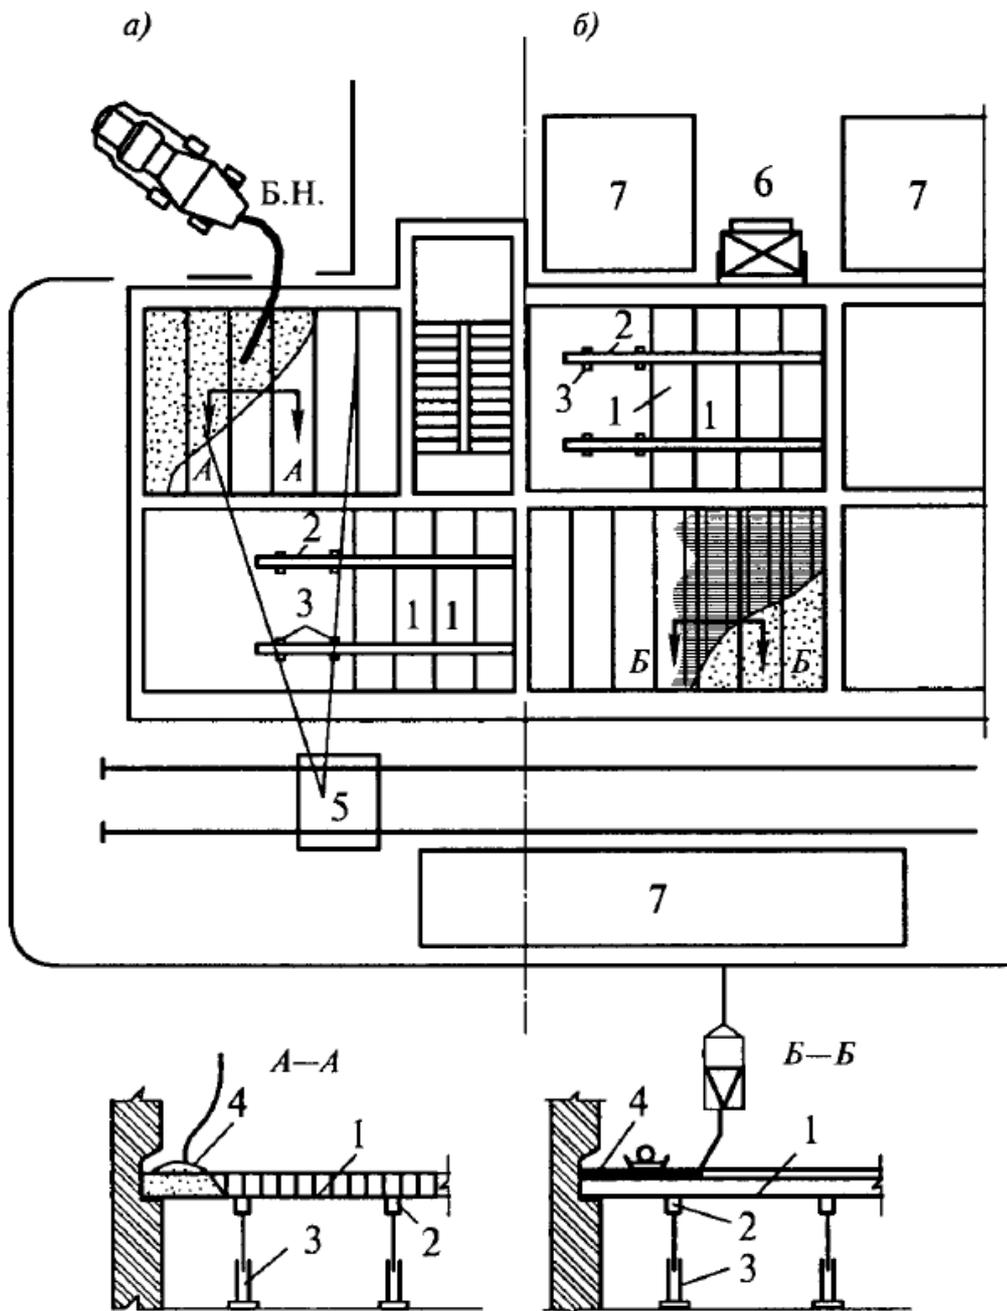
Устройство сборно-монолитных перекрытий в несъемной опалубке: а — железобетонные плиты с выпусками арматуры; б — из пеностирольных плит; 1 — несъемная опалубка; 2 — ригели; 3 — телескопические стойки; 4 — монолитный бетон; 5 — монтажный кран; 6 — подъемник грузопассажирский; 7 — зоны складирования
